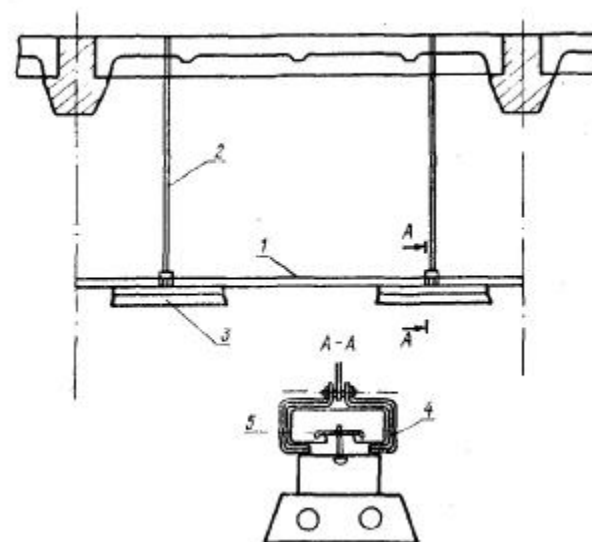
Блок из двух люминесцентных светильников на коробе КЛ-1
